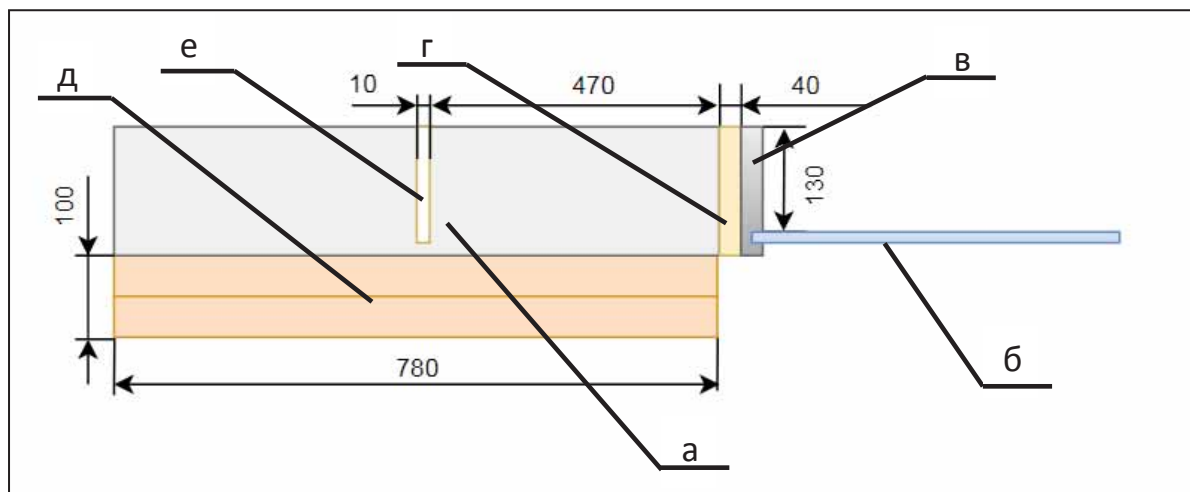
Схема узла исследуемого фрагмента. Дефект кладки прямоугольной формы, толщиной 10 мм, высота 140 мм, глубина 190 мм., утепление наружной поверхности стены 100 мм: а – стена; б – стеклопакет; в - оконный профиль; г - пенный шов; д – утеплитель.
